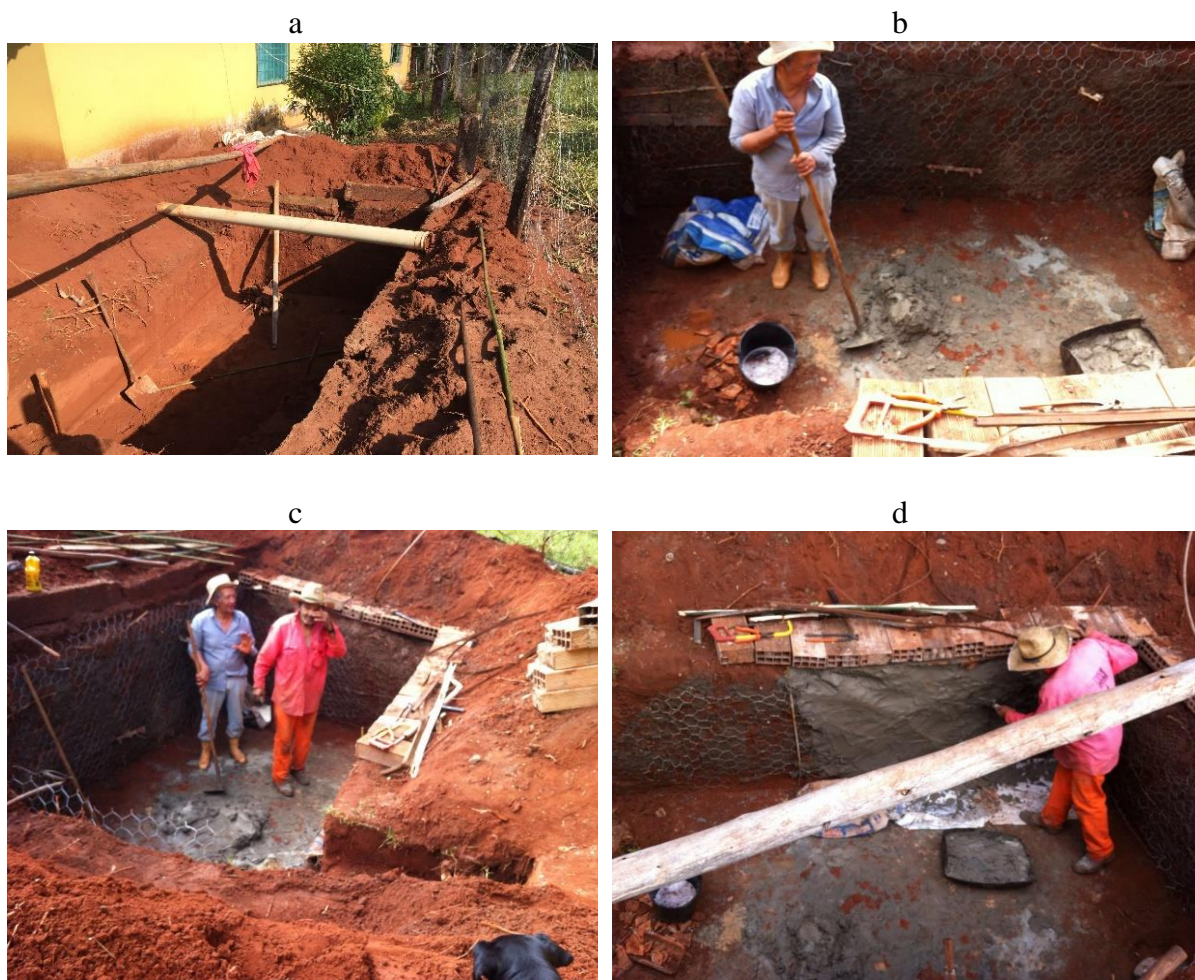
Escavação da trincheira (a); tela de aço galvanizado (b); posicionando a tela de aço galvanizado (c); e cimentando a trincheira (d). (Fonte: Autor)
